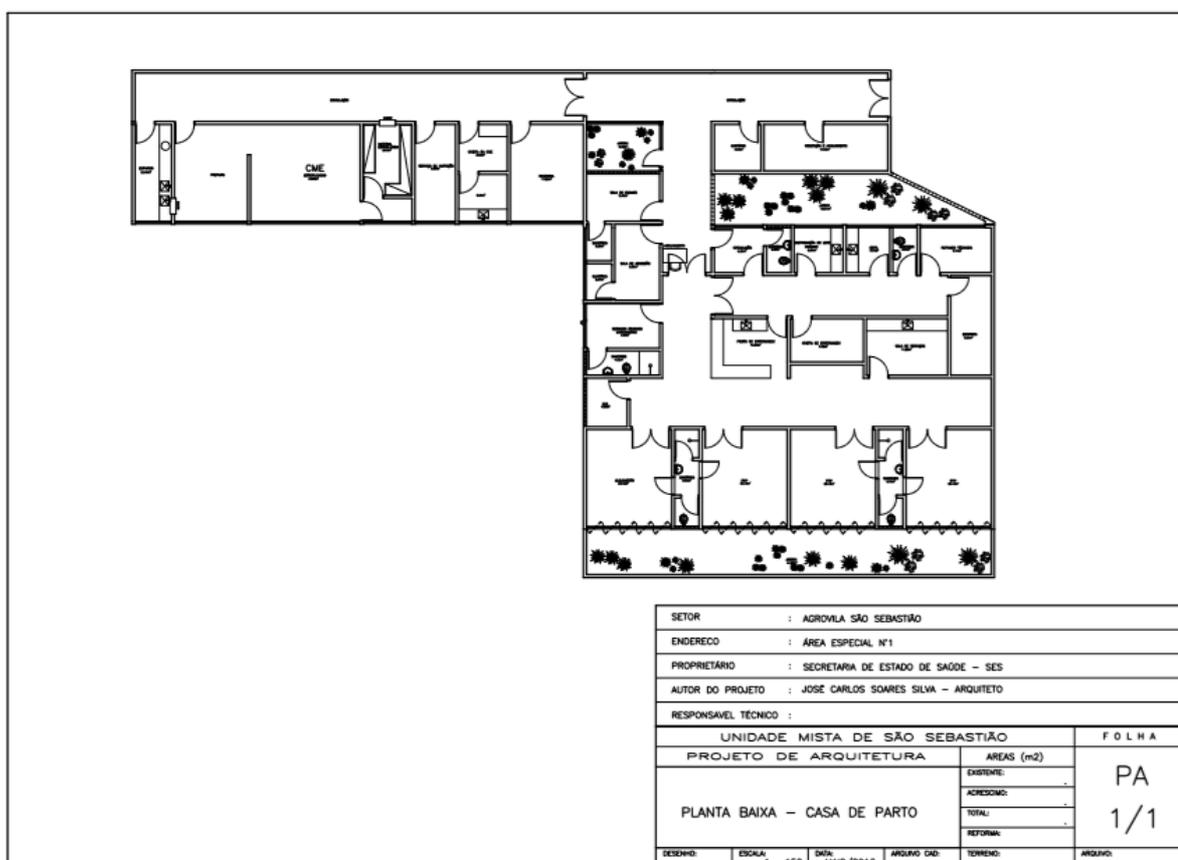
Planta baixa da Casa de Parto do São Sebastião
